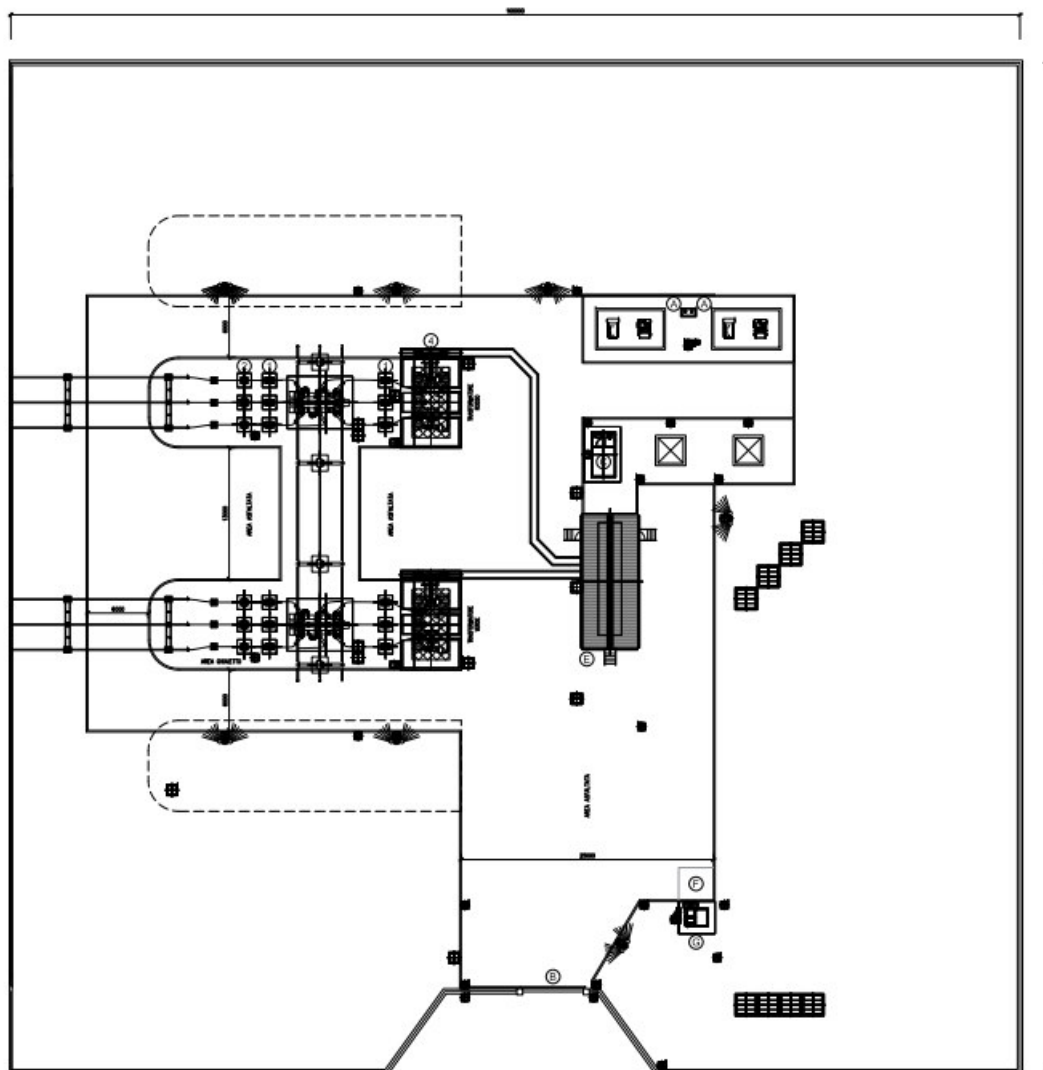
Cabina primaria Grillara: planimetria elettromeccanica
